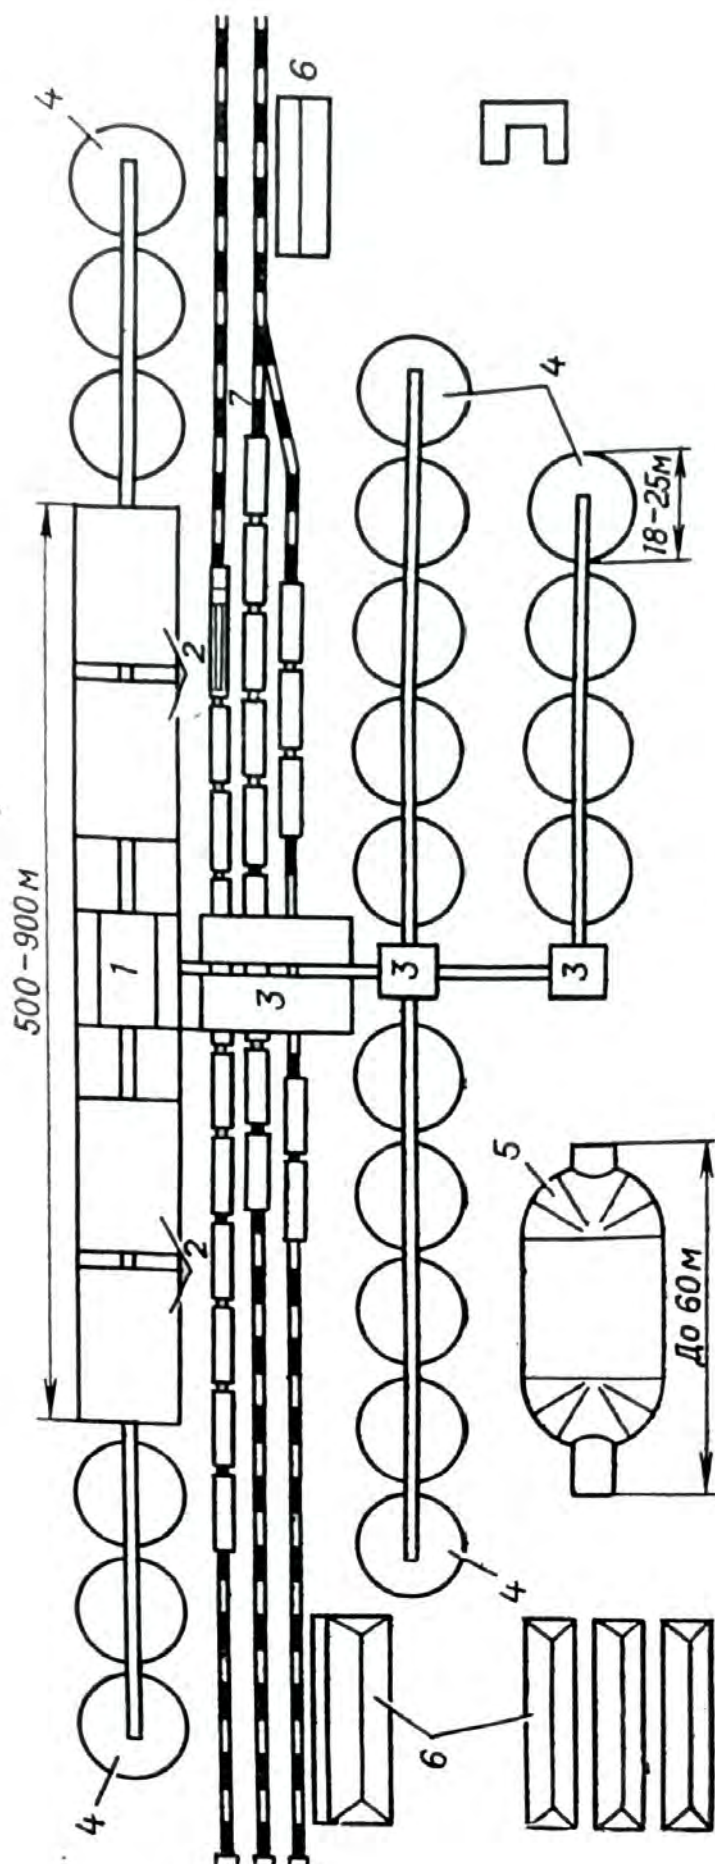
Типовая планировка и основные сооружения силосного элеватора:
